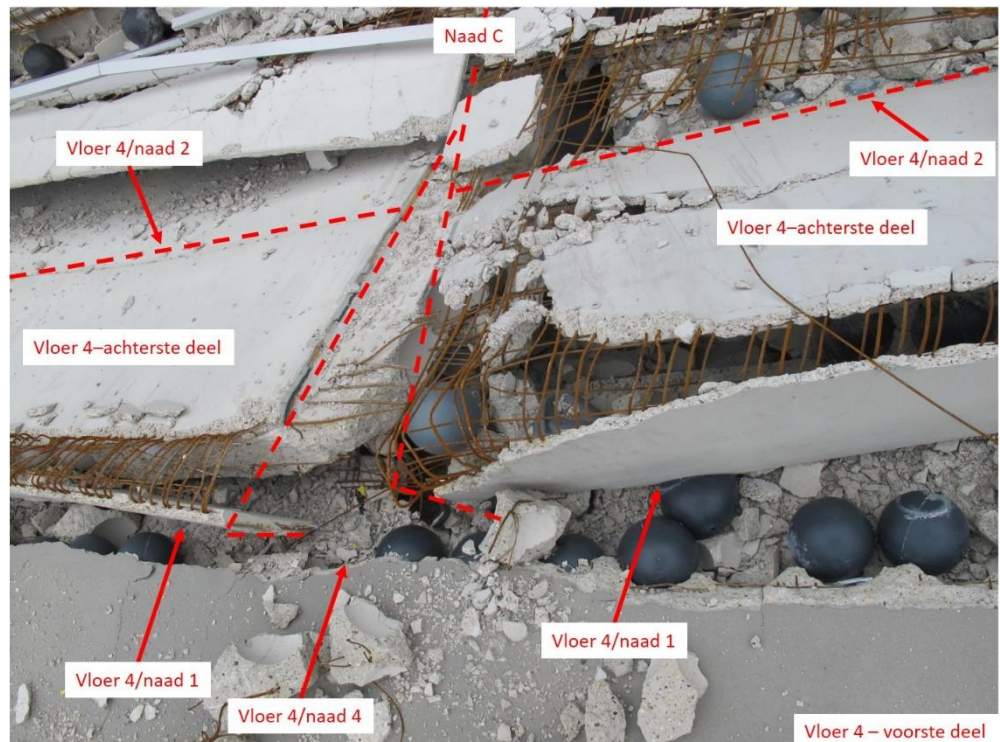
Overzicht van het ingestorte deel ter plaatse van naad C
